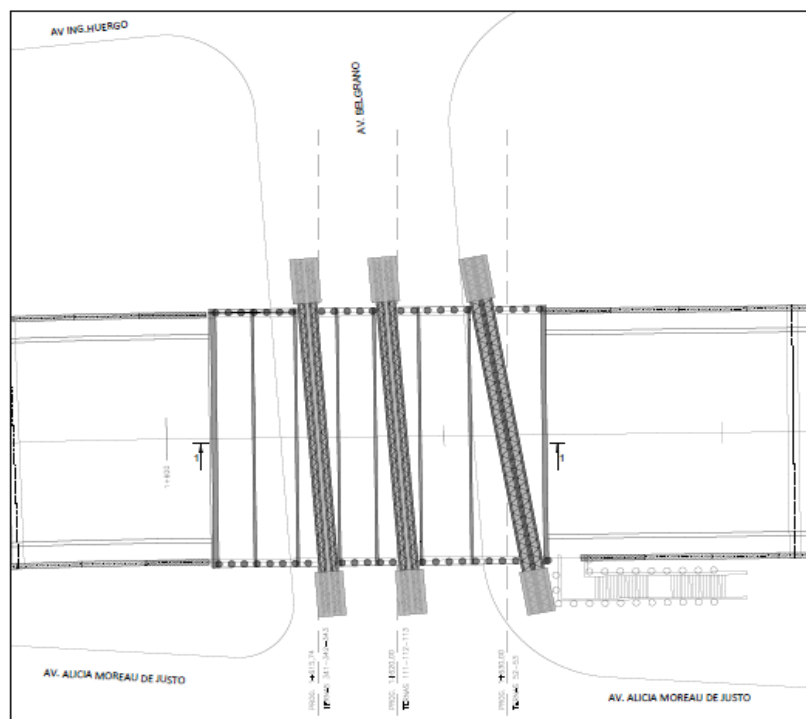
Esquema en planta de ternas de alta tensión en puente de Av. Belgrano
